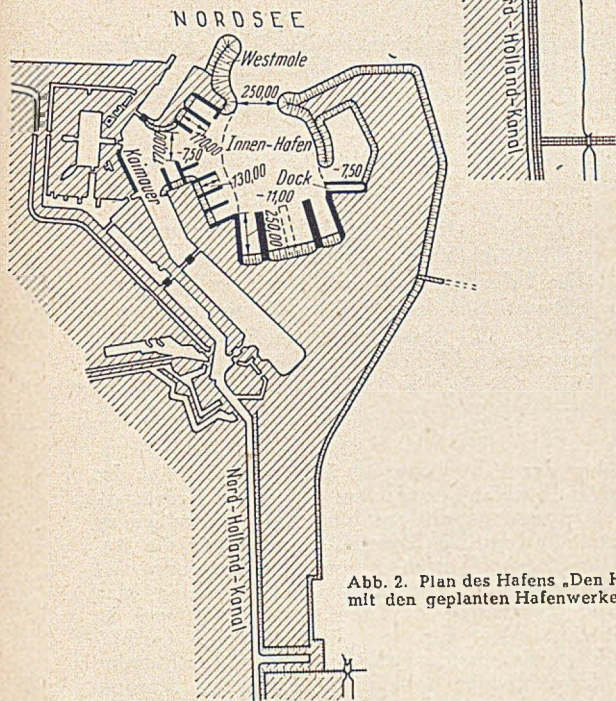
Plan des Hafens „Den Helder“ mit den geplanten Hafenwerken.
